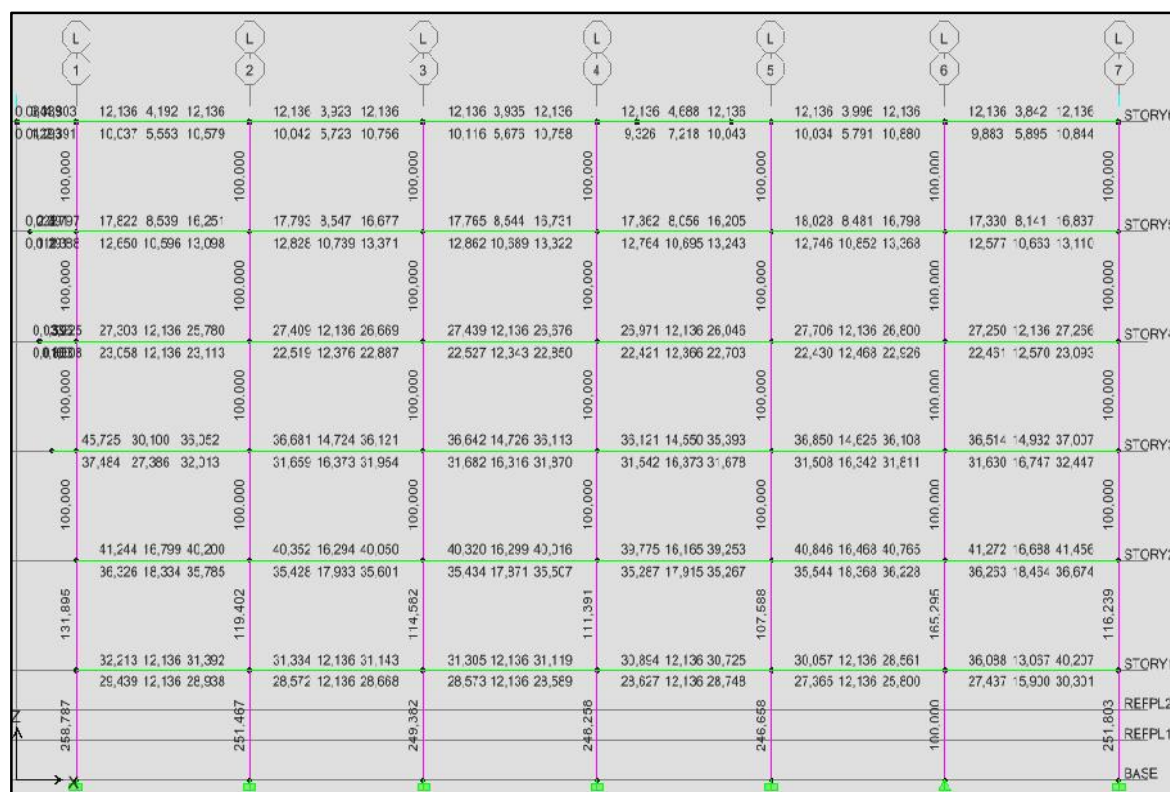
Acero en vigas pórtico I, Gobernantes
